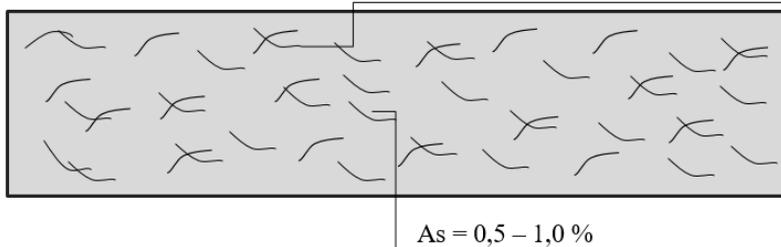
Схема армирования фибробетона проволокой с ЭПФ
